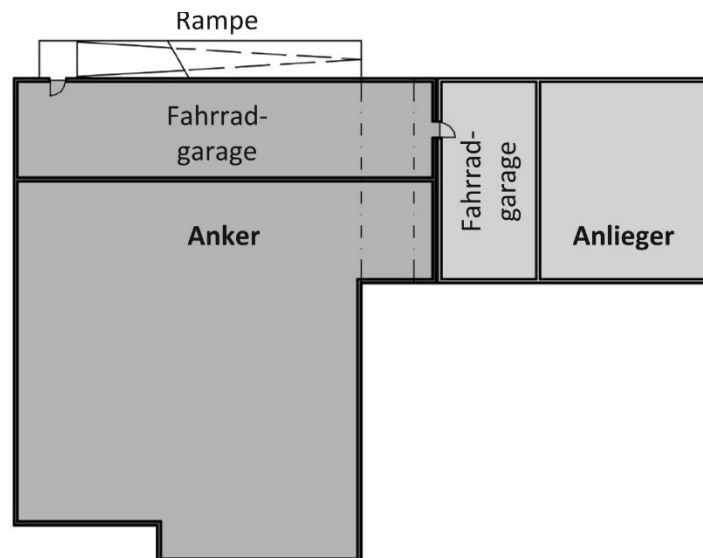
schematischer Grundriss des Untergeschosses von MU 7 (ohne Maßstab)
